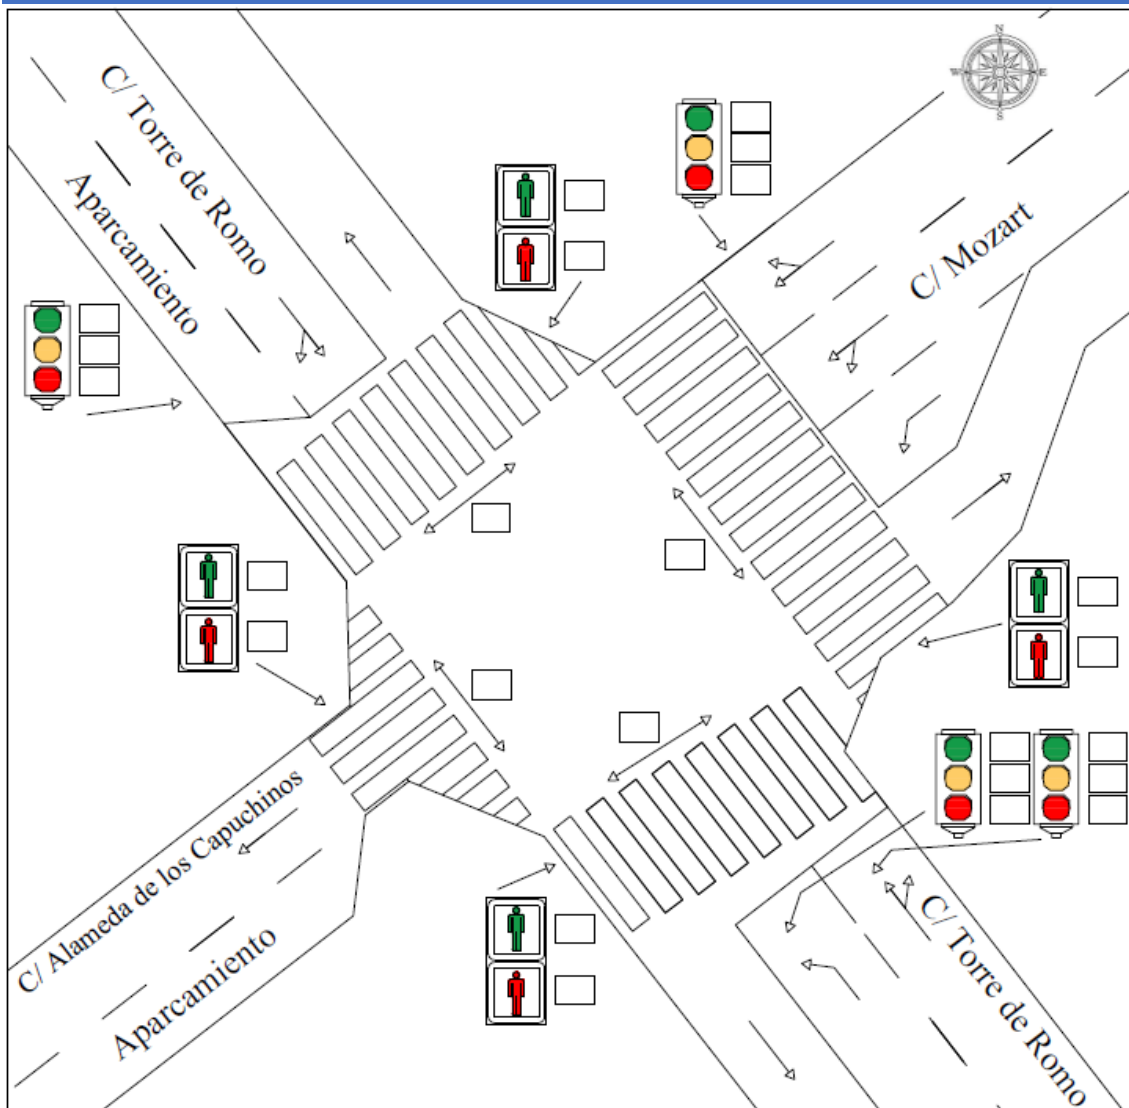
Croquis intersección nº3. Fuente: Elaboración propia
